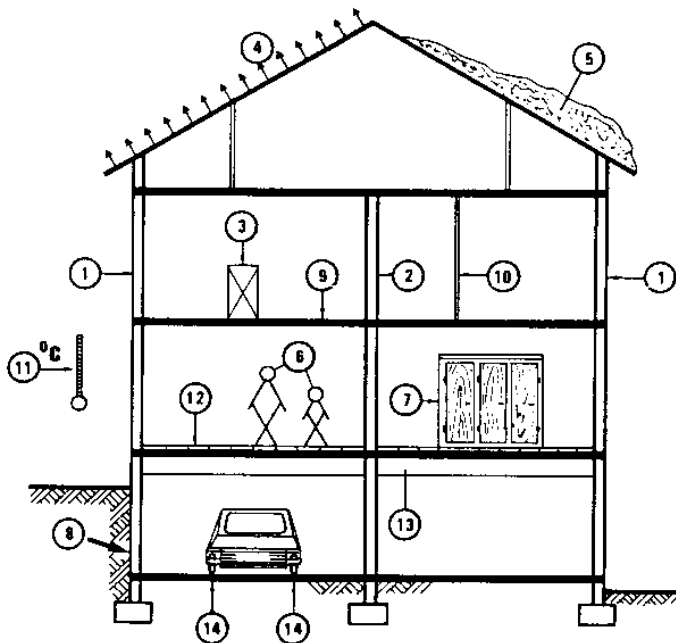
Coupe schématique d'un bâtiment à 4 niveaux.
